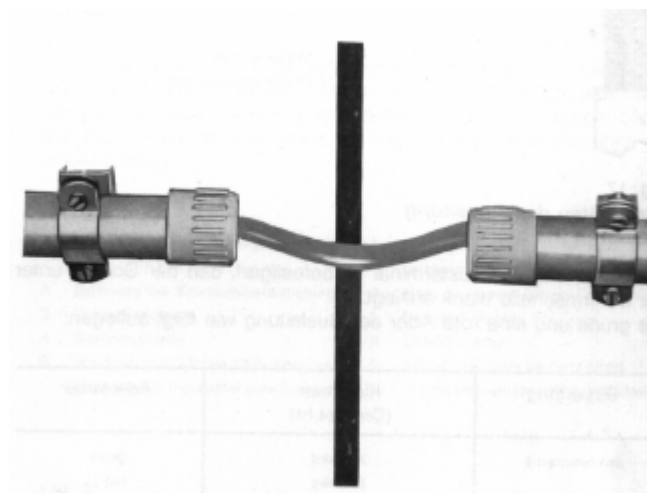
Interruption du tube de protection au niveau d'un joint de dilatation
